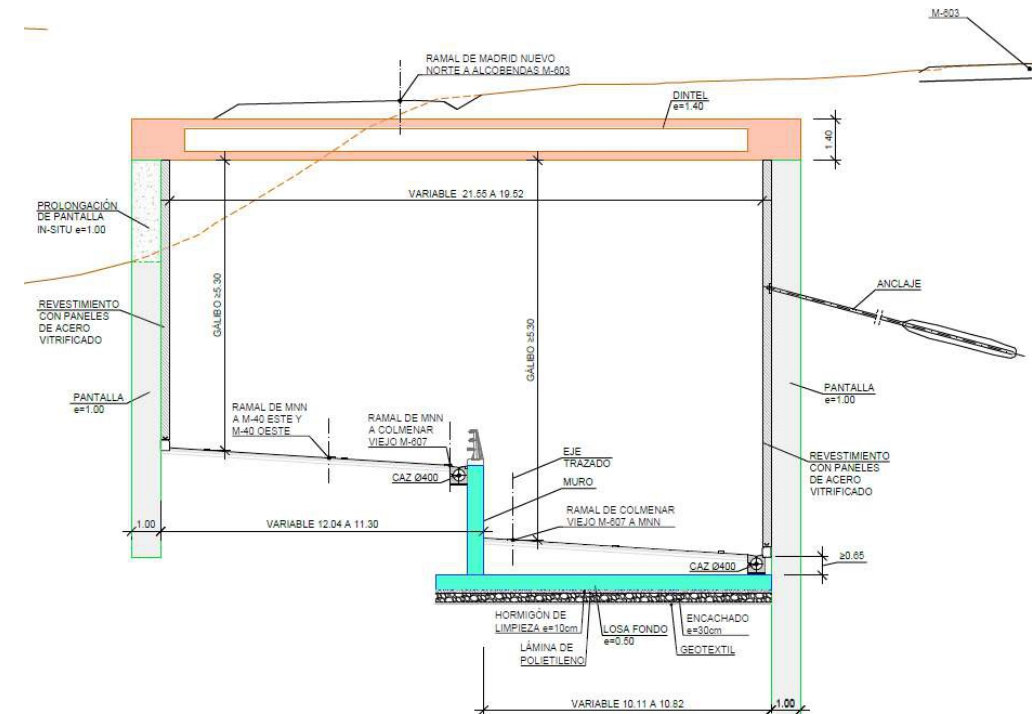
Sección tipo con losa de fondo en un sentido y muro en voladizo intermedio. Dintel aligerado de 1.40 m. Pantallas margen derecha ancladas. Falso túnel Sur (1B, 2B y 3B)
